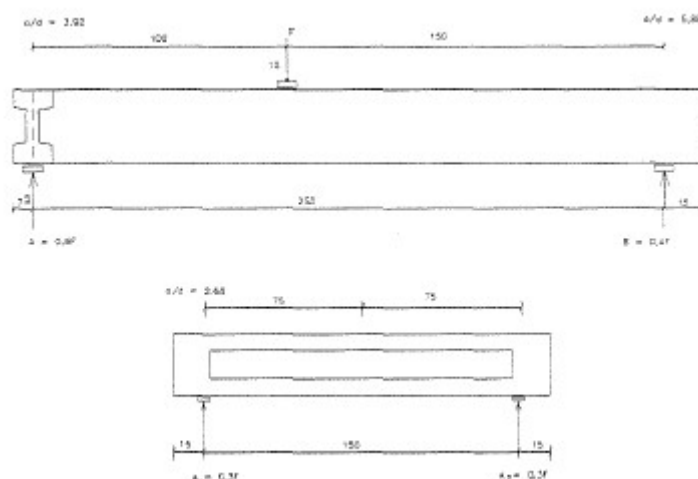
Esquema da aplicação das cargas nas vigas dos ensaios B1-L e B1-R
